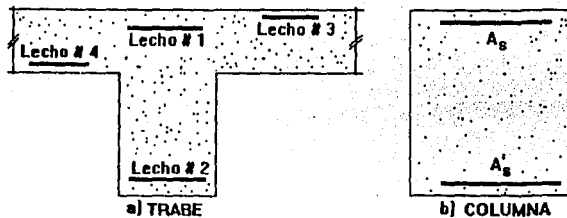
Localización del acero en secciones tipo de los elementos estructurales.
